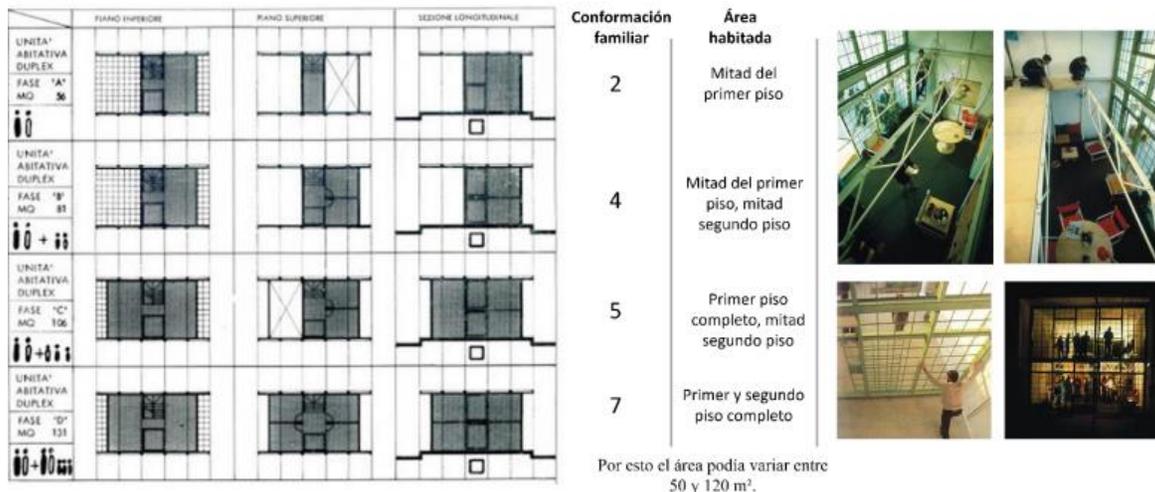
Crecimiento de la Casa Evolutiva en planta y sección + imagen de apoyo
